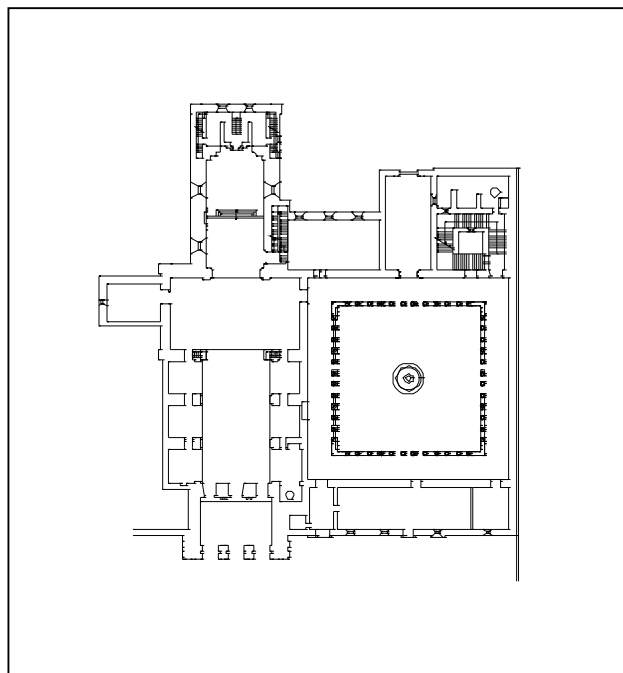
Planta da igreja e do claustro (Most. de Grijó)
